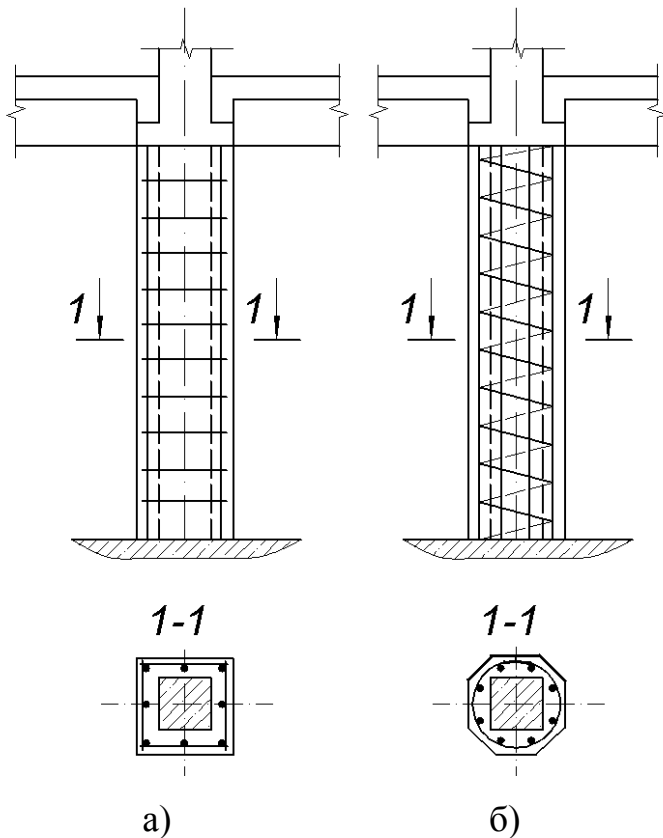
Варіанти підсилення колон залізобетонними обоймами
